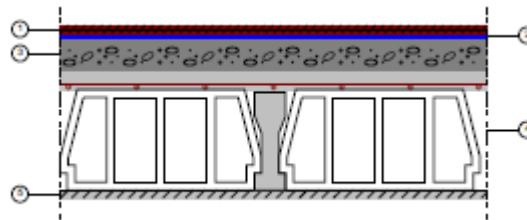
Detalle de los componentes del forjado entre plantas.
